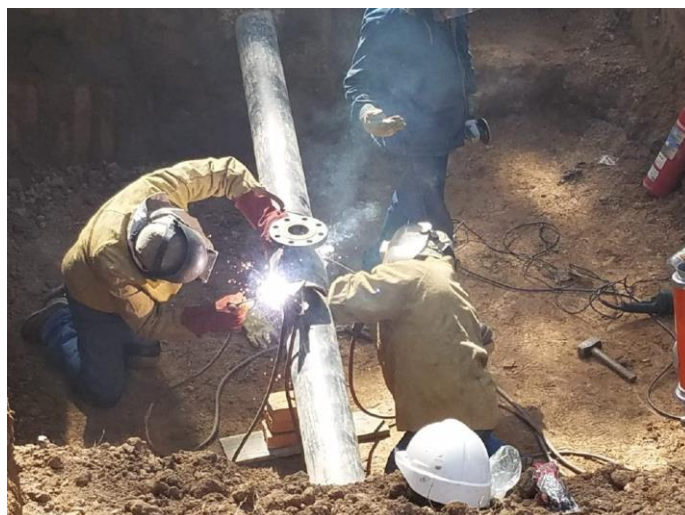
Soldadores realizando el empalme de Gasoducto
